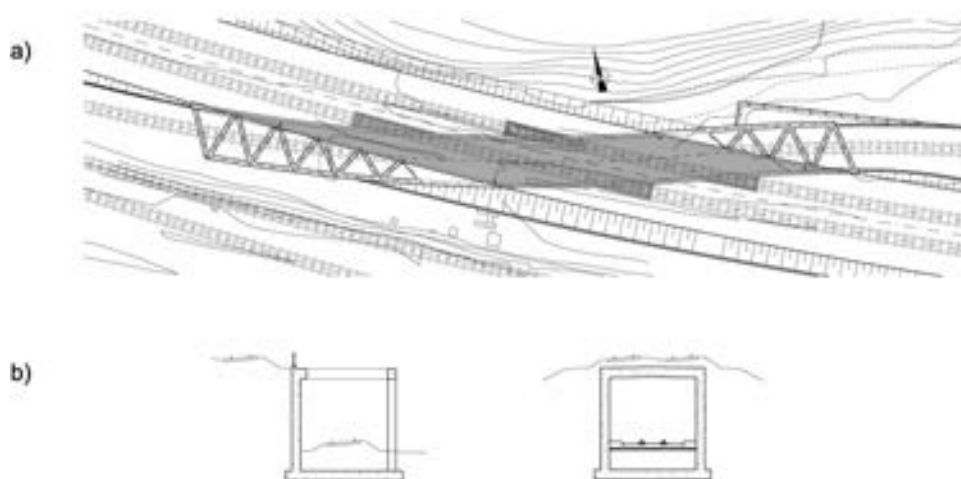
Pérgola en la L.A.V. Córdoba-Málaga en Málaga; a) Planta; b) Secciones transversales
